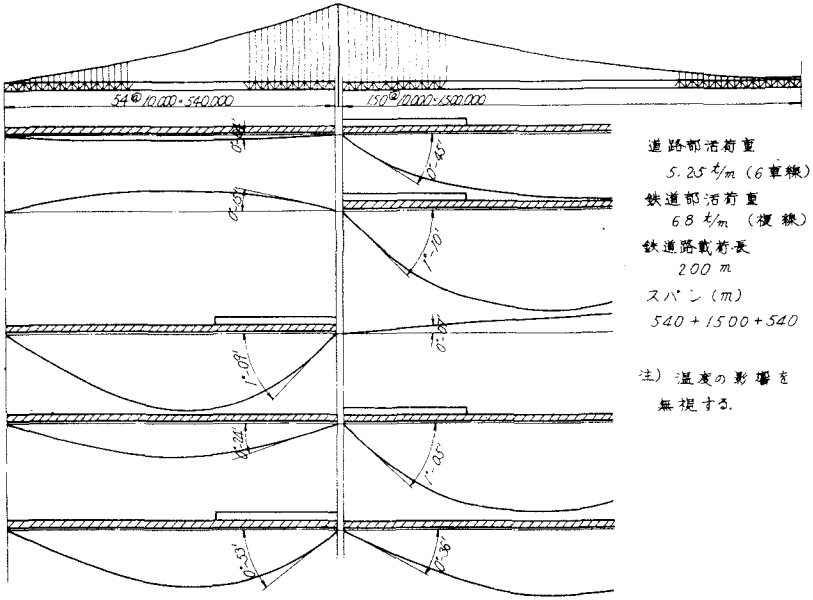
吊橋の撓み角の計算値例 (ヒンジ)
